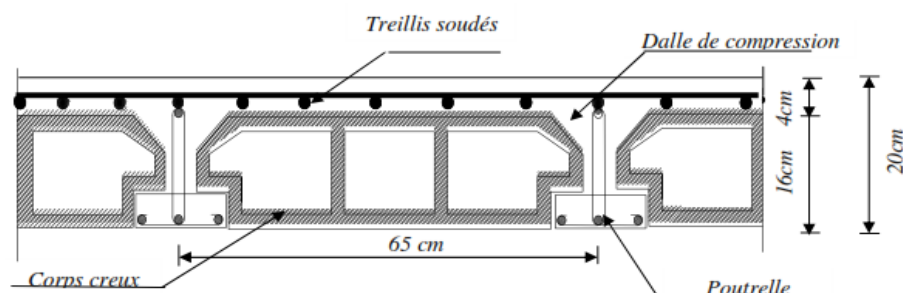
Coupe transversale d'un plancher en corps creux (16+4)
